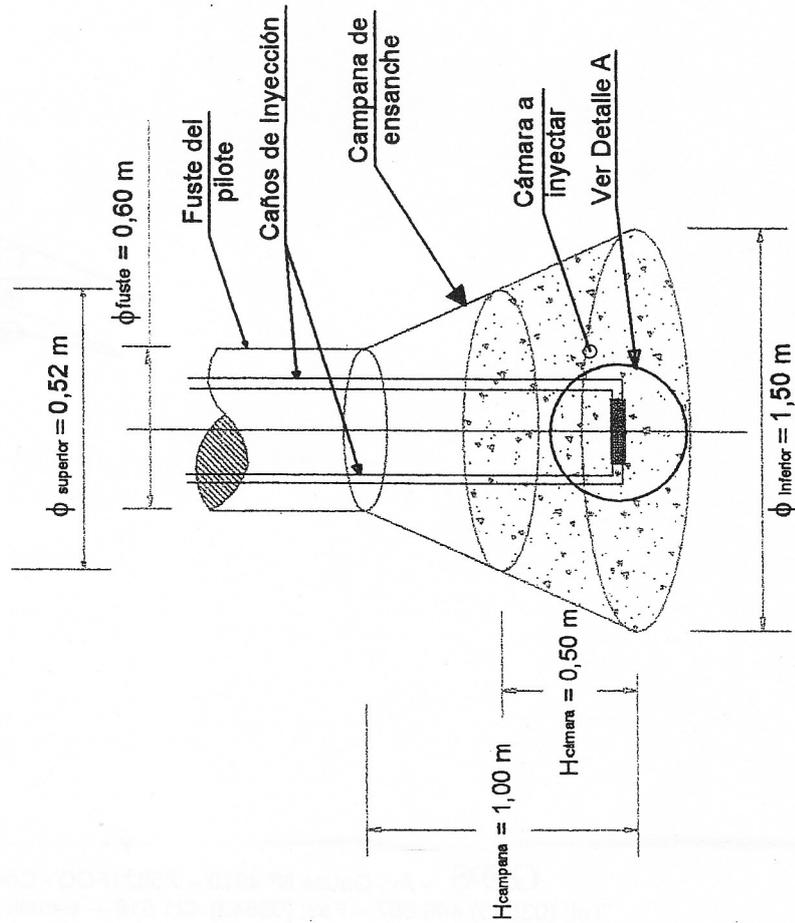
Detalles de cámara de inyección por la punta del pilote y de manguito sobre línea de inyección
